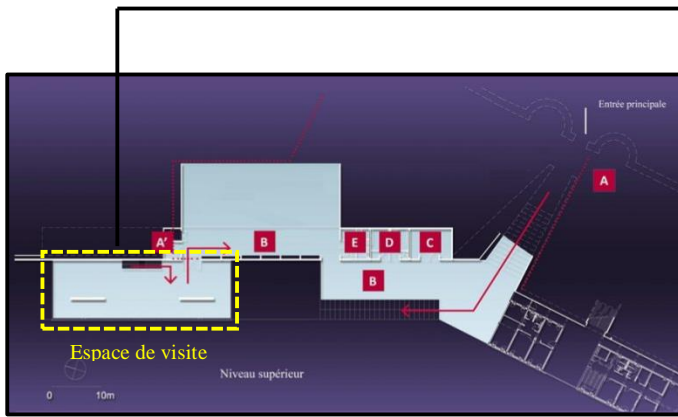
Plan de niveau supérieur du centre d'interprétation de Volubilis
